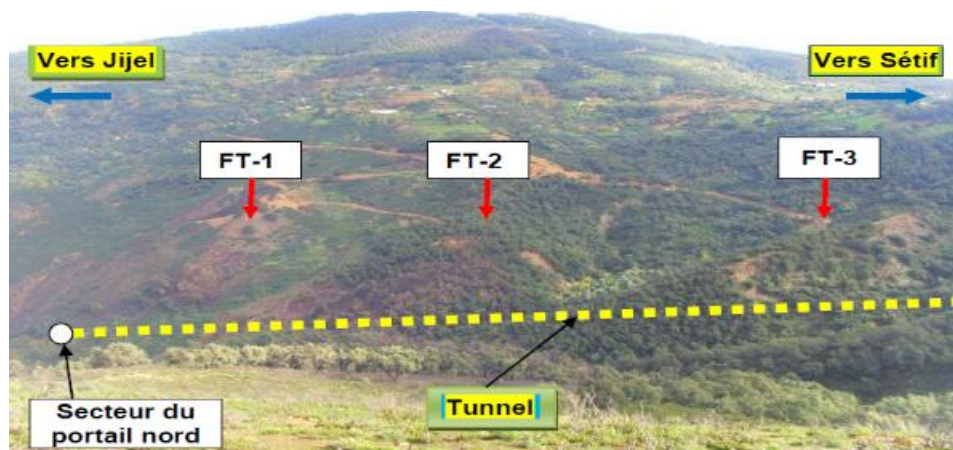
Aperçu général du secteur nord du tunnel (vue vers l'est).
